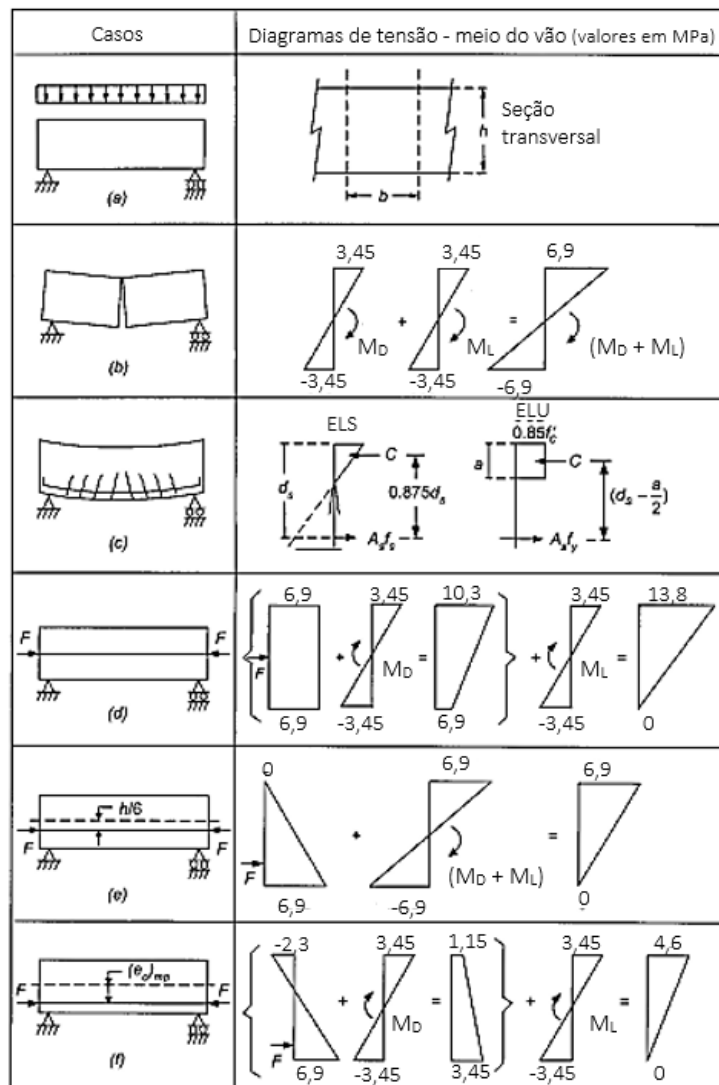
Exemplos de consideração da protensão em um elemento de concreto. Adaptado de (Naaman, 2012)
